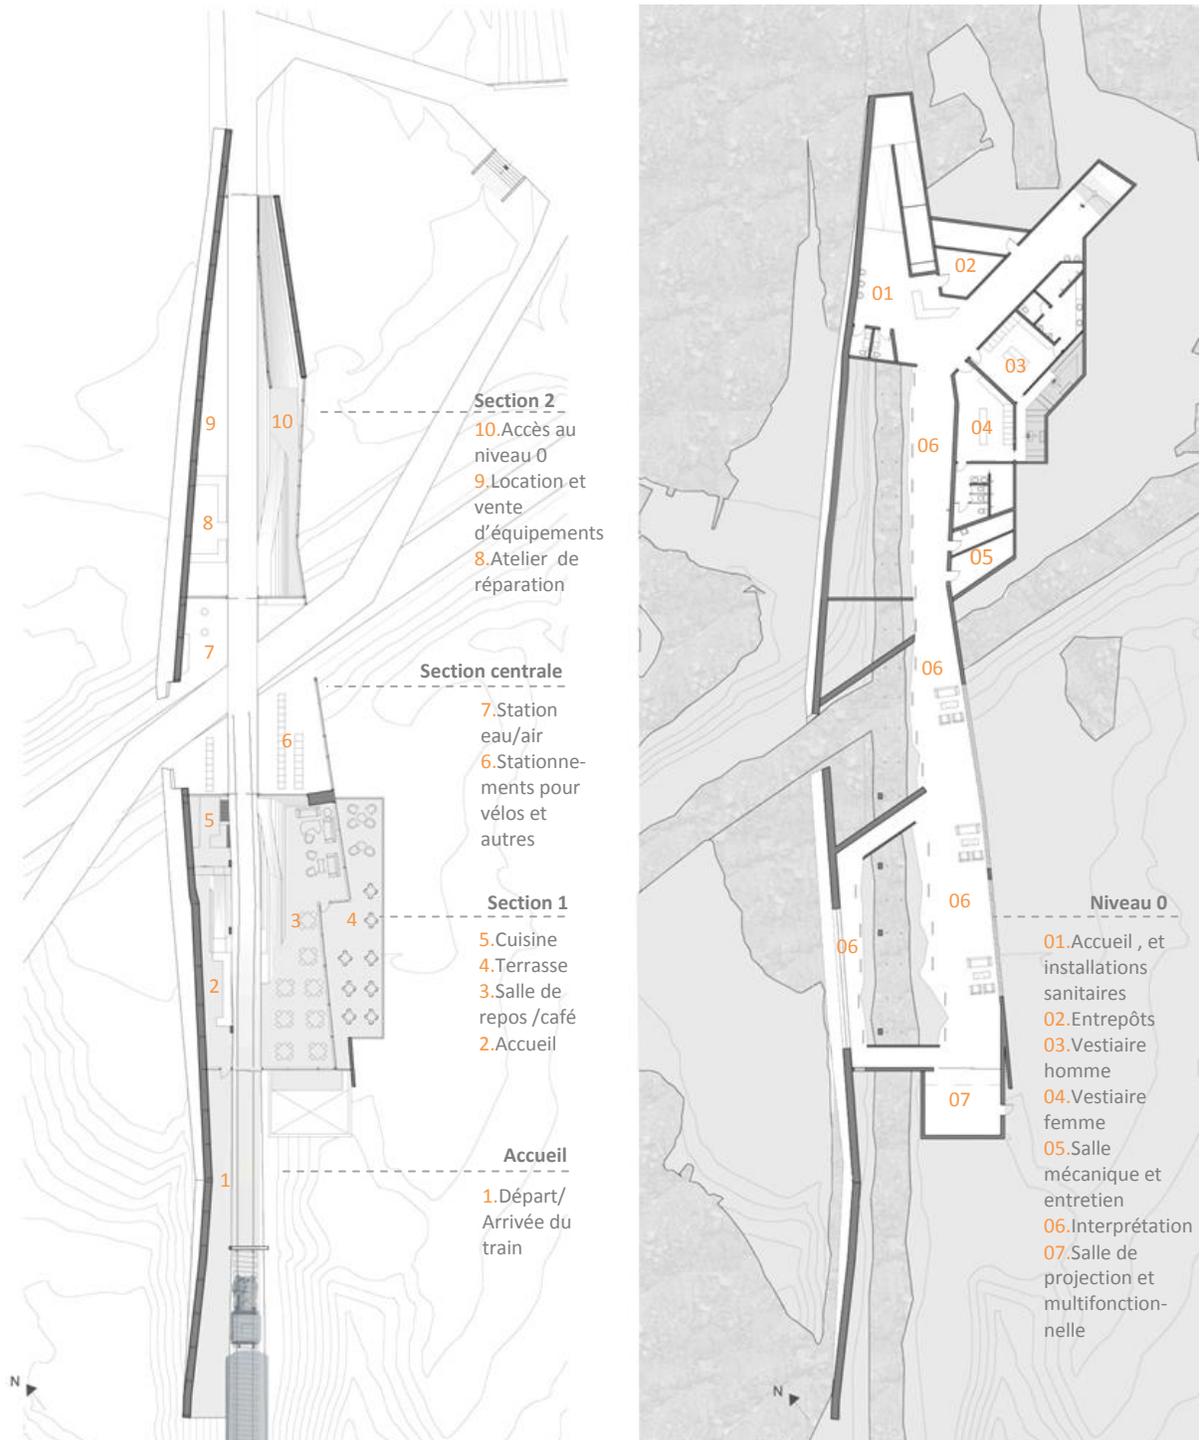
Plan du rez-de-chaussée (gauche) et plan du sous-sol (droite)
